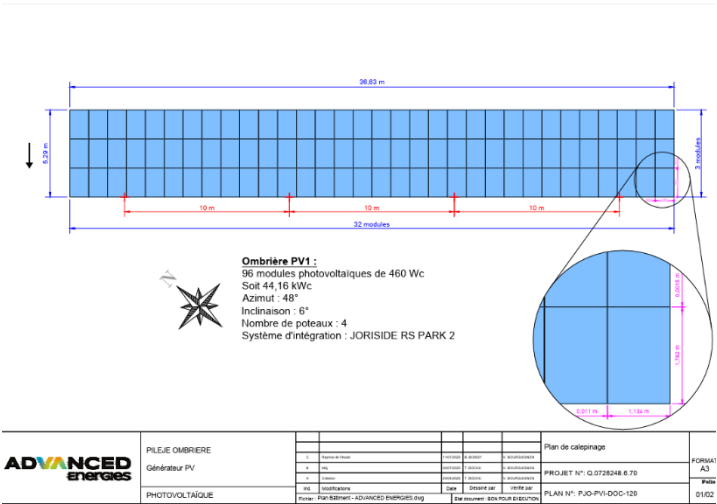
Plan de calepinage du projet d'installation d'ombrières PV
